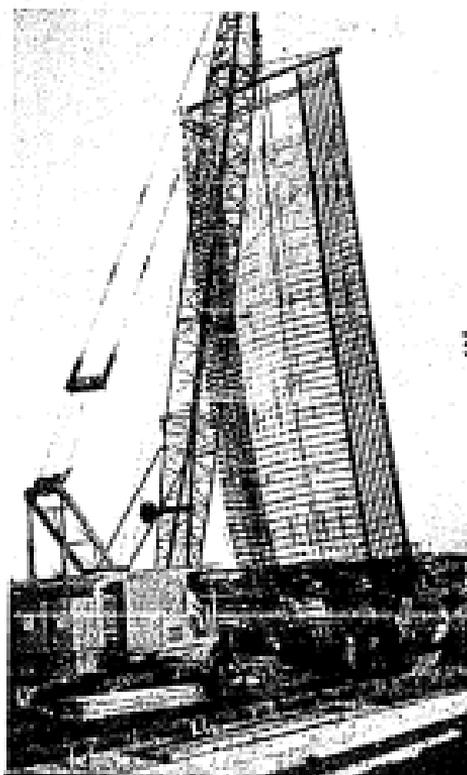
PARRILLA DE ACERO DE REFUERZO
